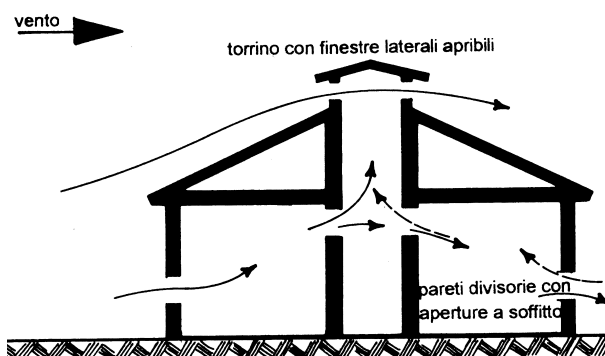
Utilizzo di finestre a torrino sul tetto ,per incrementare, senza l'ausilio di ventilatori, la ventilazione naturale ad estrazione favorita dall'effetto camino: si incrementano i flussi d'aria entrante ed uscente da un edificio.
